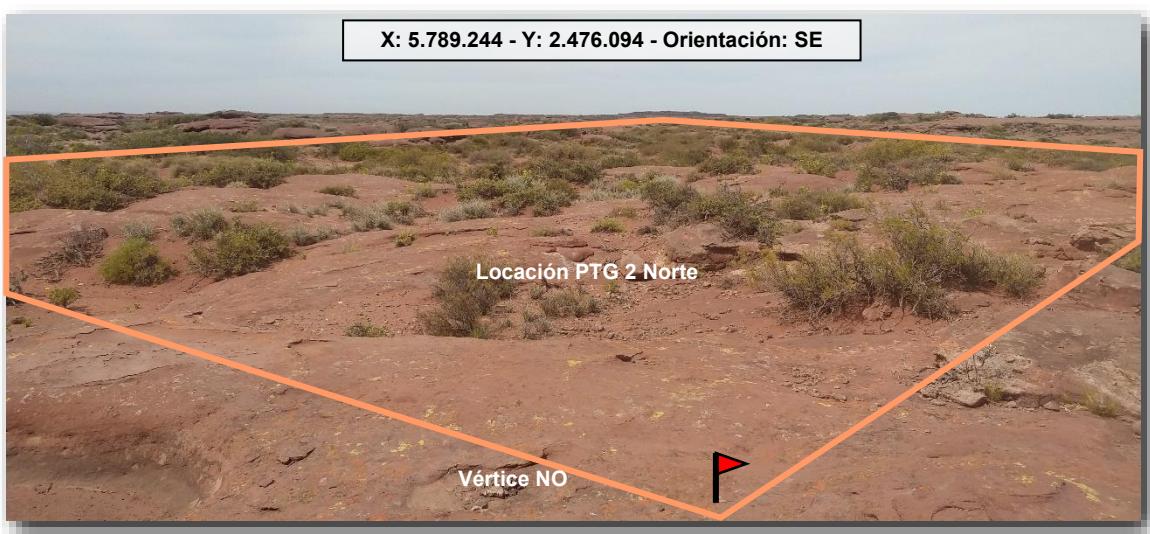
Futura locación de PTG 2 Norte vista desde el esquinero Noroeste.
